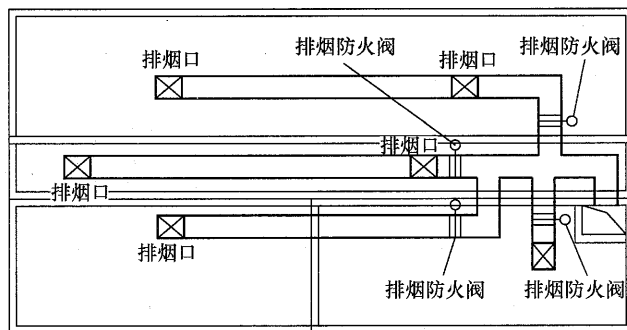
排烟管道在排烟支管上设排烟防火阀平面图
